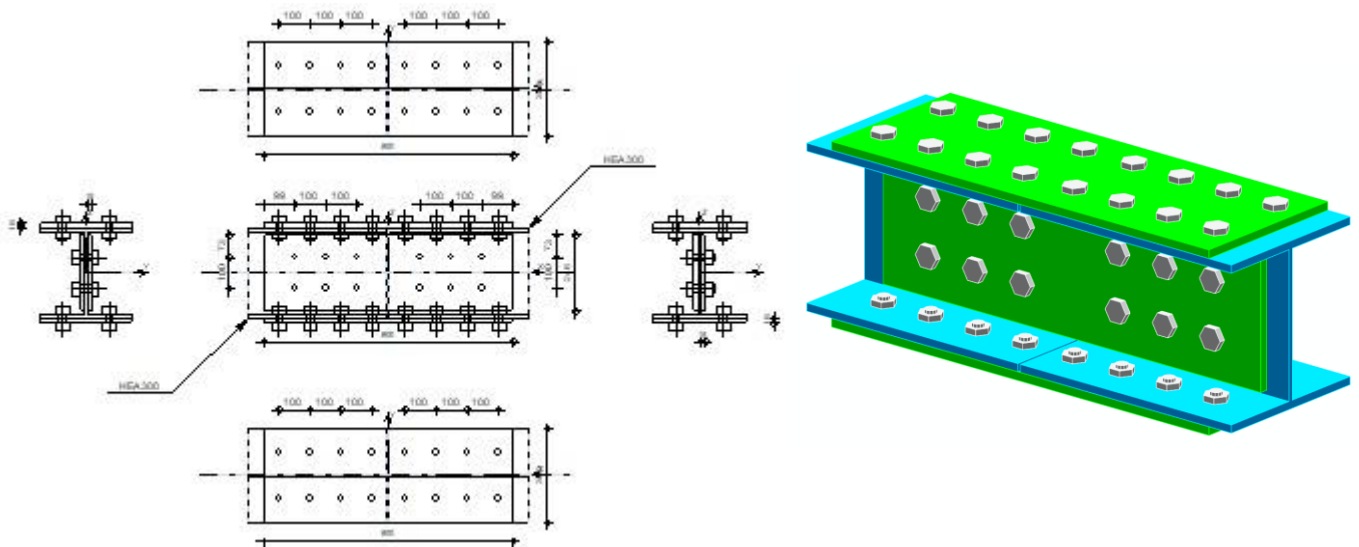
Vue 3D de l'assemblage épissure de la poutre et détail de l'assemblage épissure de la poutre
